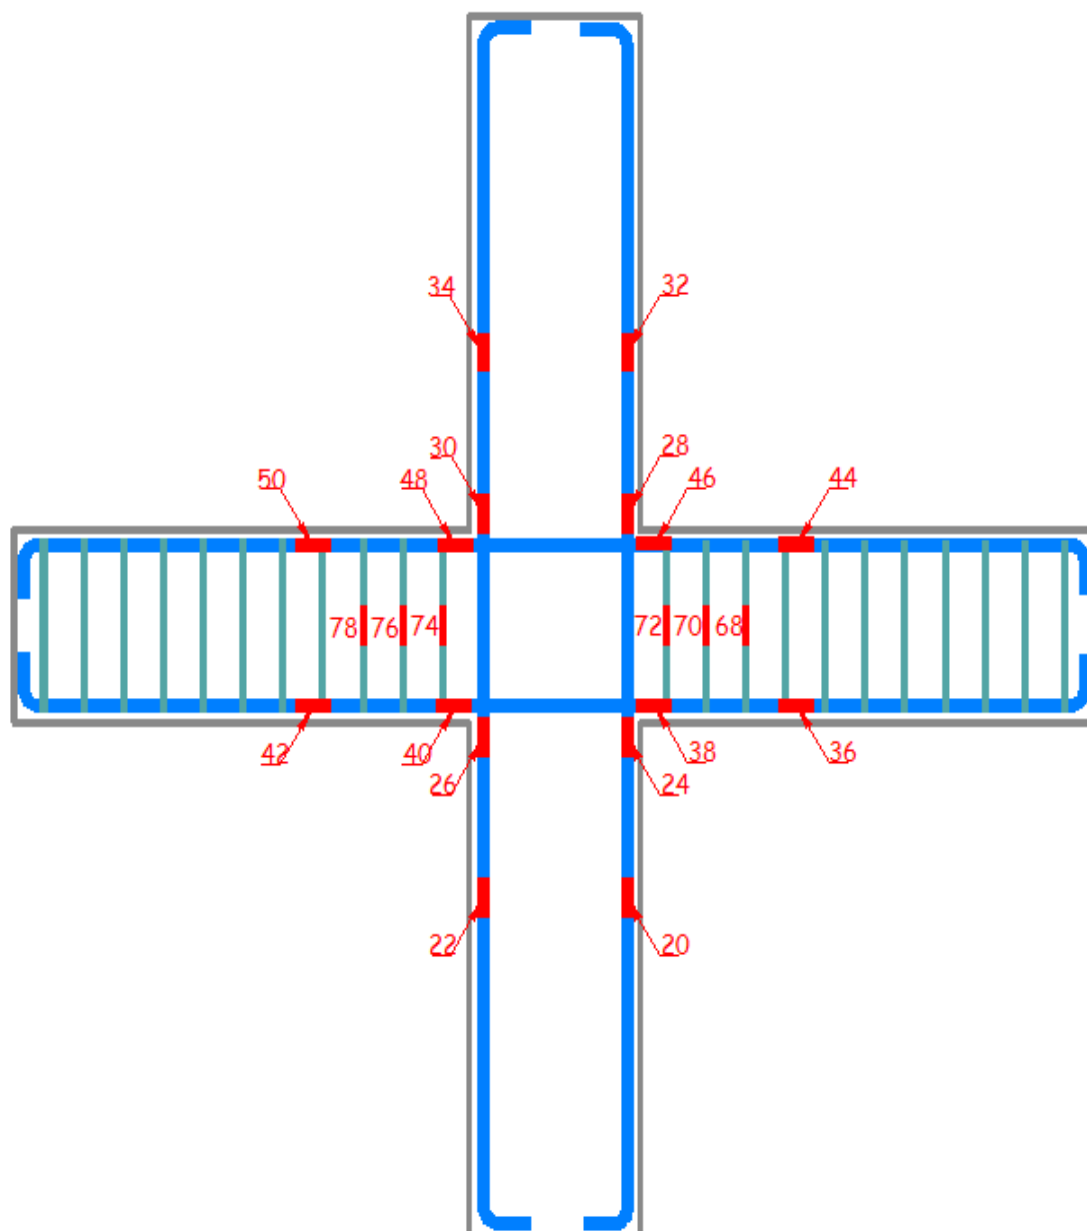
Planta espécimen de prueba para numeración de strain gages en acero de refuerzo.
